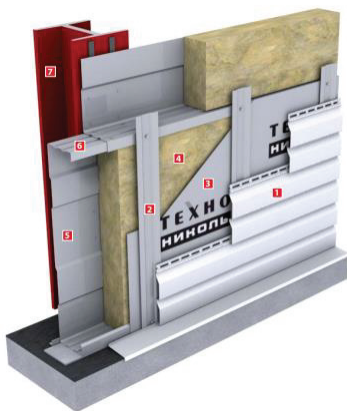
Конструкция фасада из сборных сэндвич-панелей:
